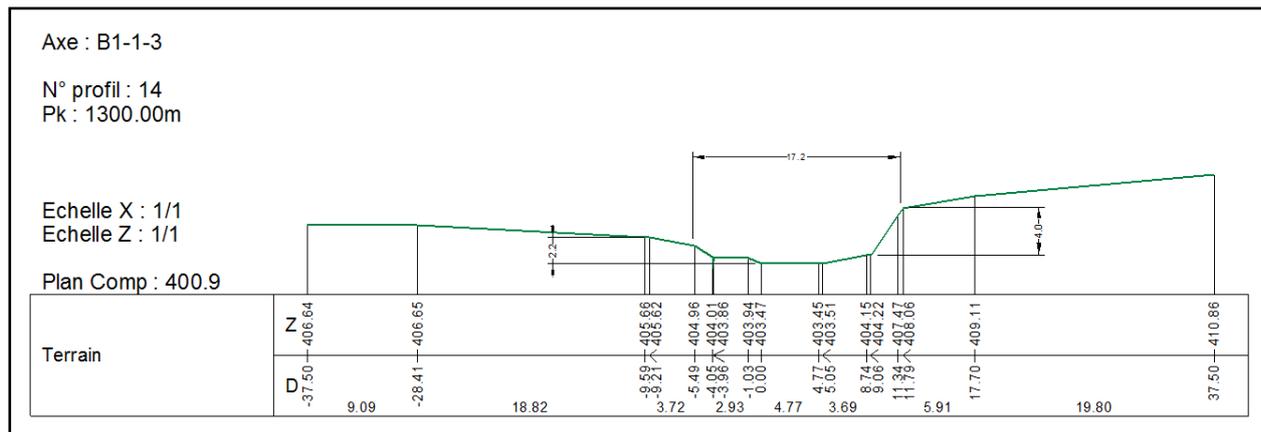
Profil en travers 1 du Guiers Mort à St-Laurent du Pont.
